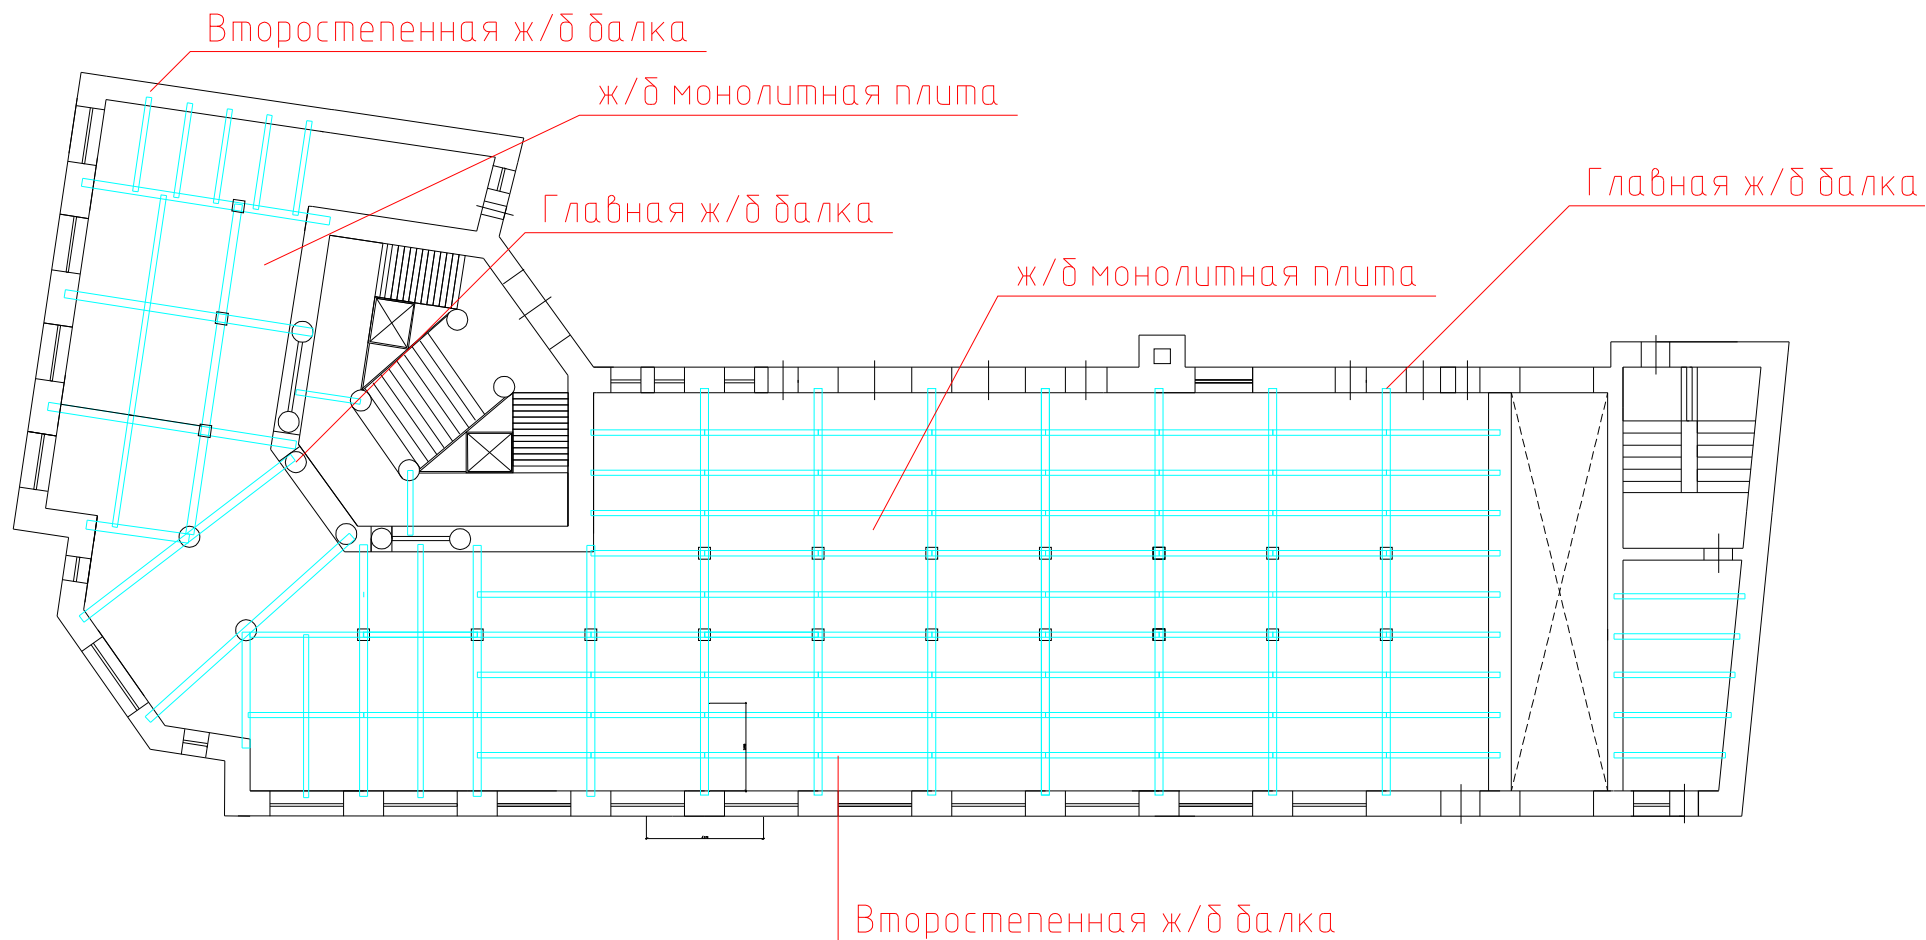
Схема главных и второстепенных балок монолитного перекрытия над первым этажом
